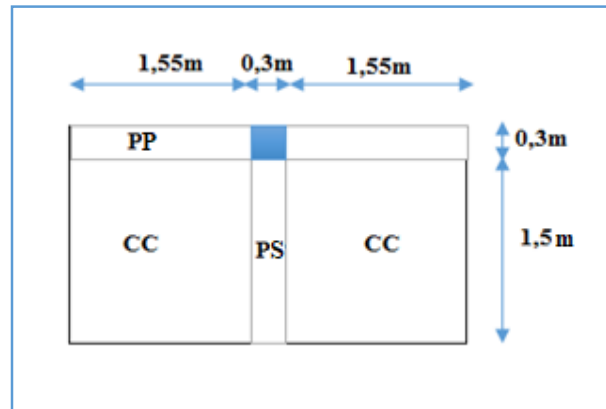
La surface reprise par le poteau de rive « Niveau RDC ».
